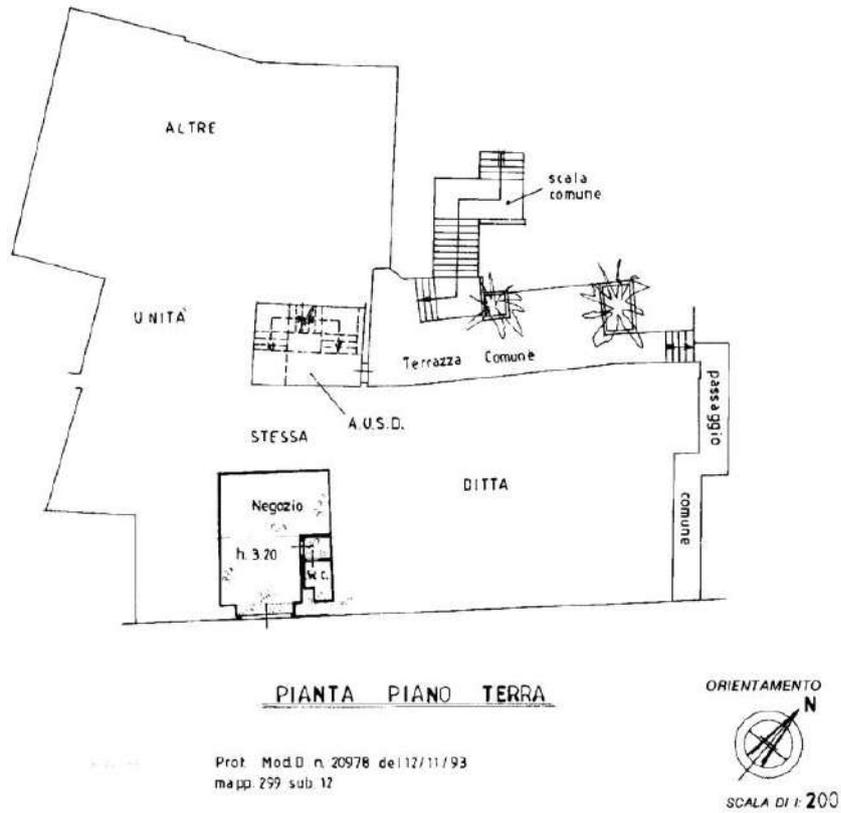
Stralcio planimetria catastale negozio – particella 299 sub. 12 – Piano Terra
